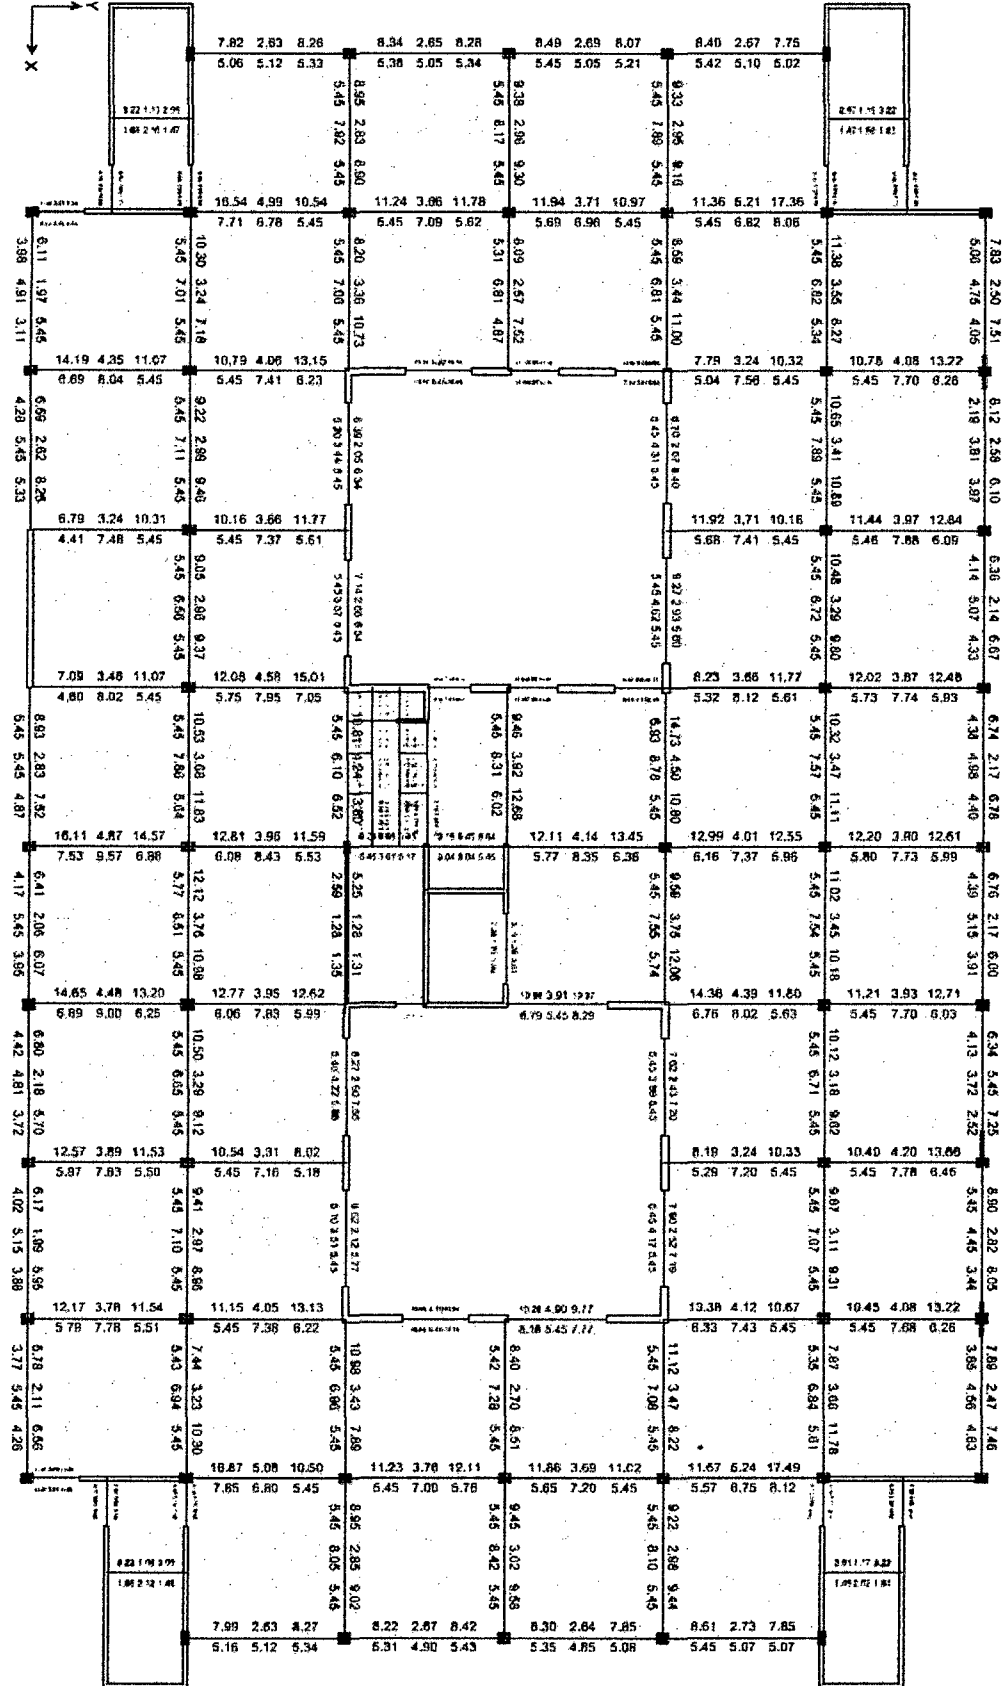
, Estructura convencional, Verificación de elementos estructurales - Piso 2.
